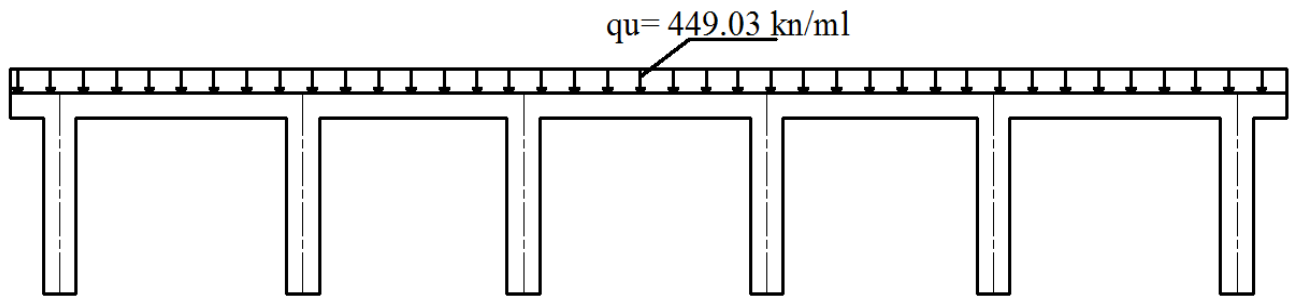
Sollicitation revenant à la poutre de rigidité
